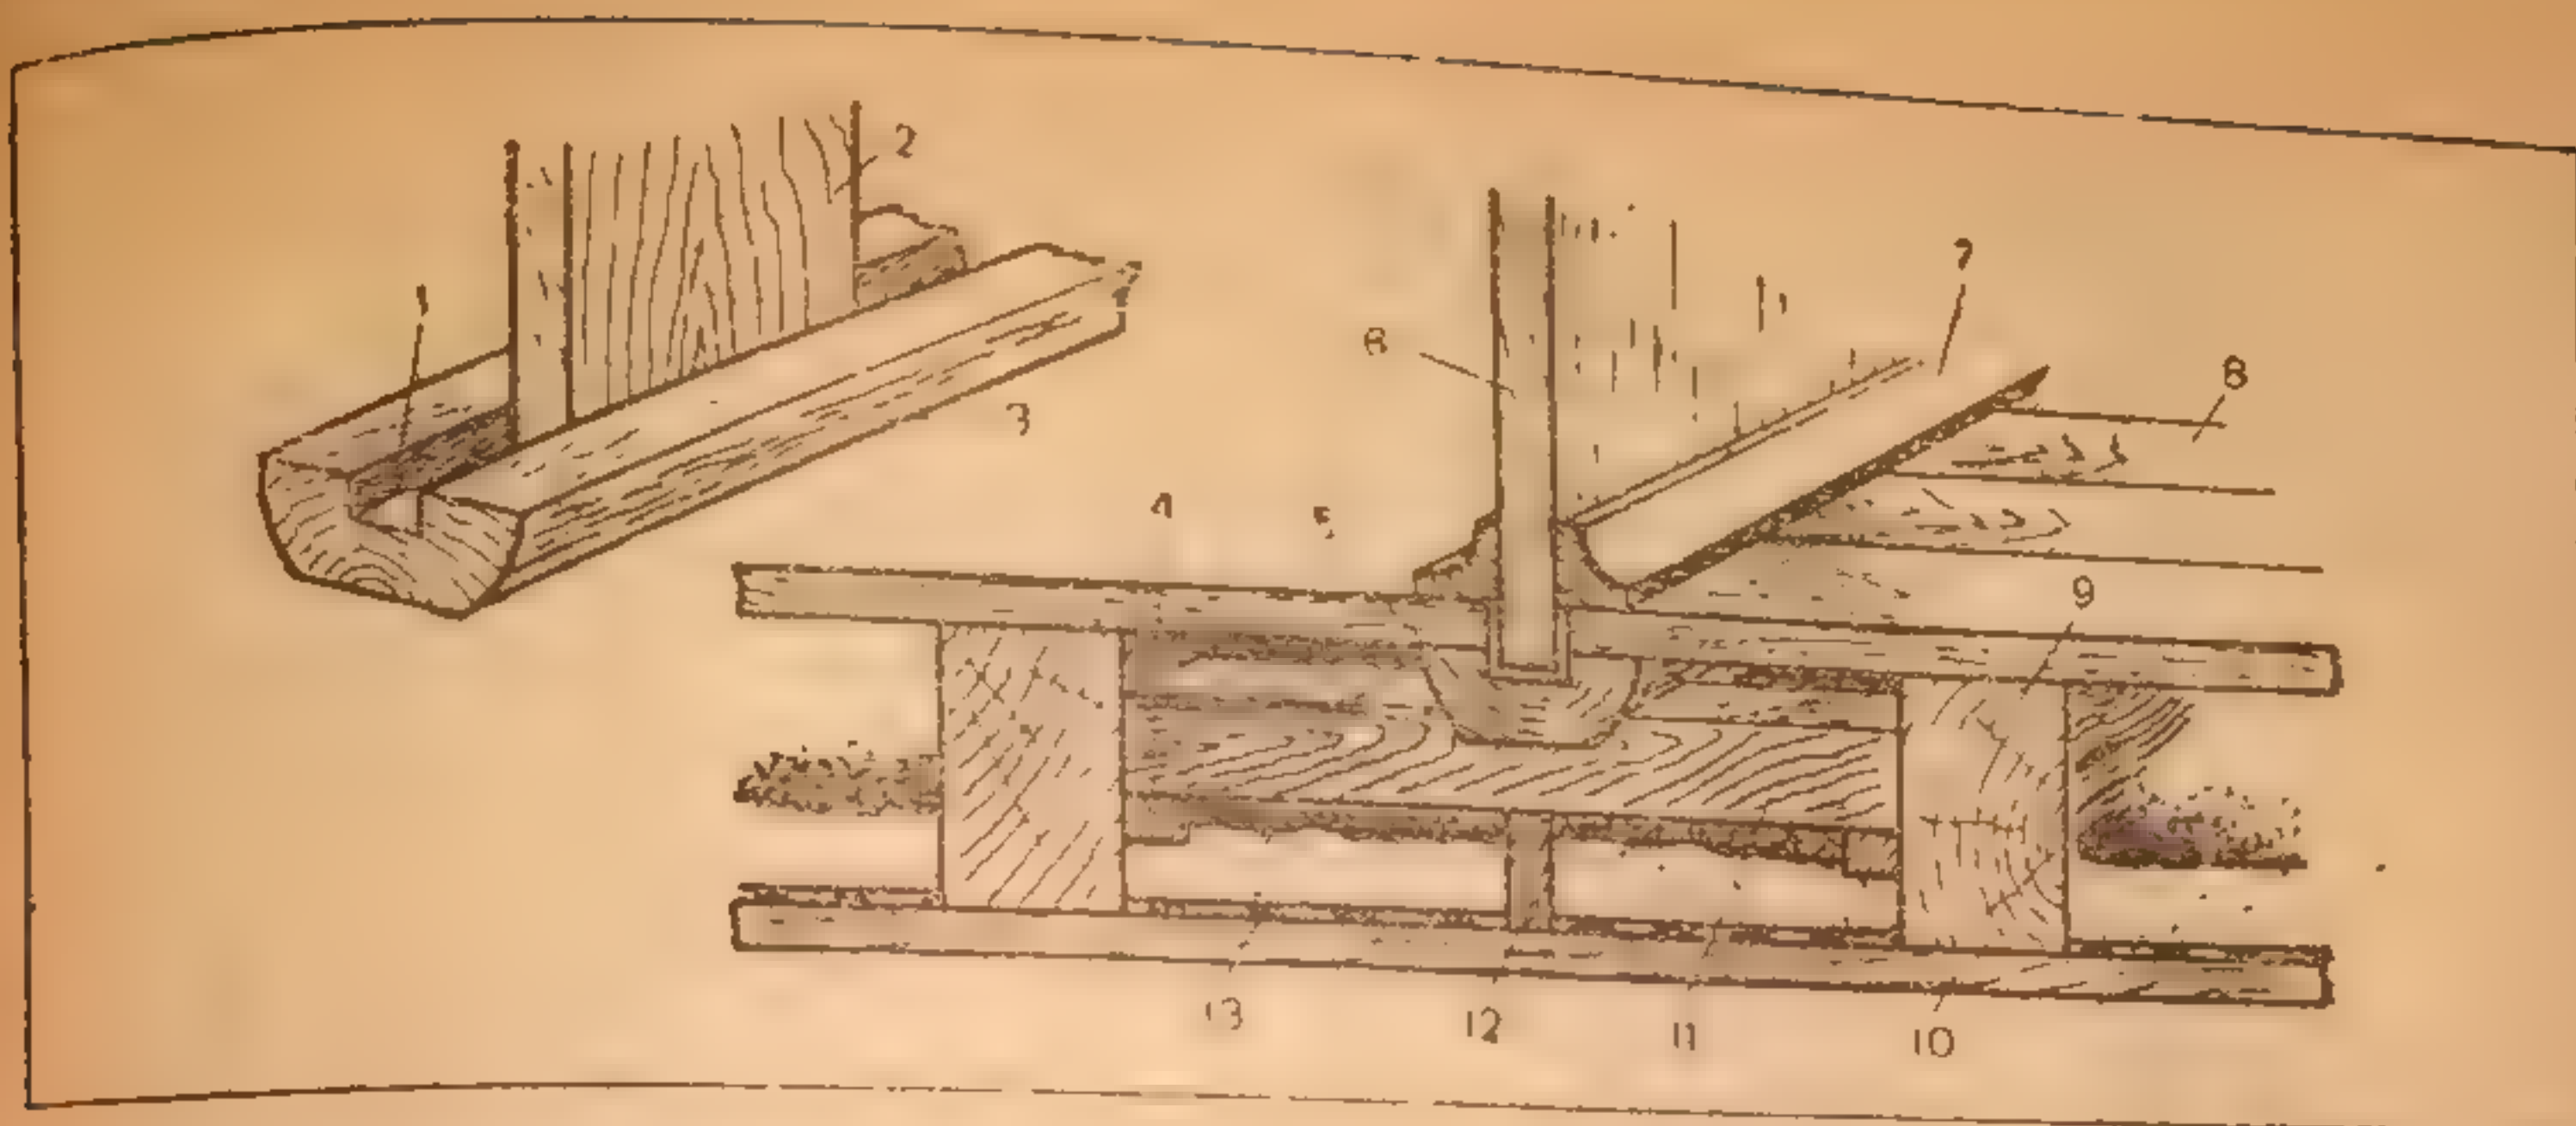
Перегородка располагается между балками и опирается на шпалу:
